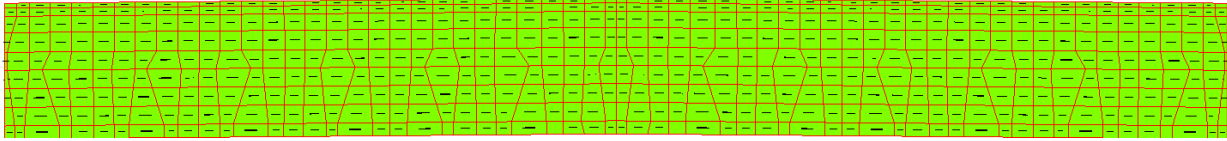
Armatura platea impalcato di Estradosso direzione 3
